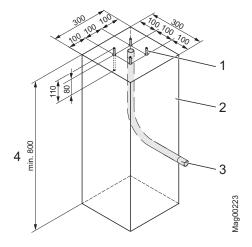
Plan de base de postes de soporte y postes de la barrera fotoeléctrica
